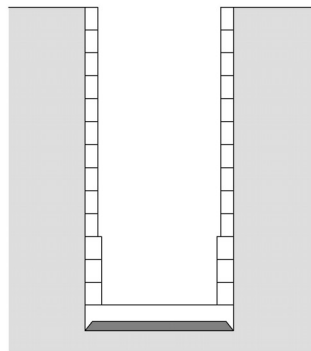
非常口の施工概要 (ケーソン工法の場合)
